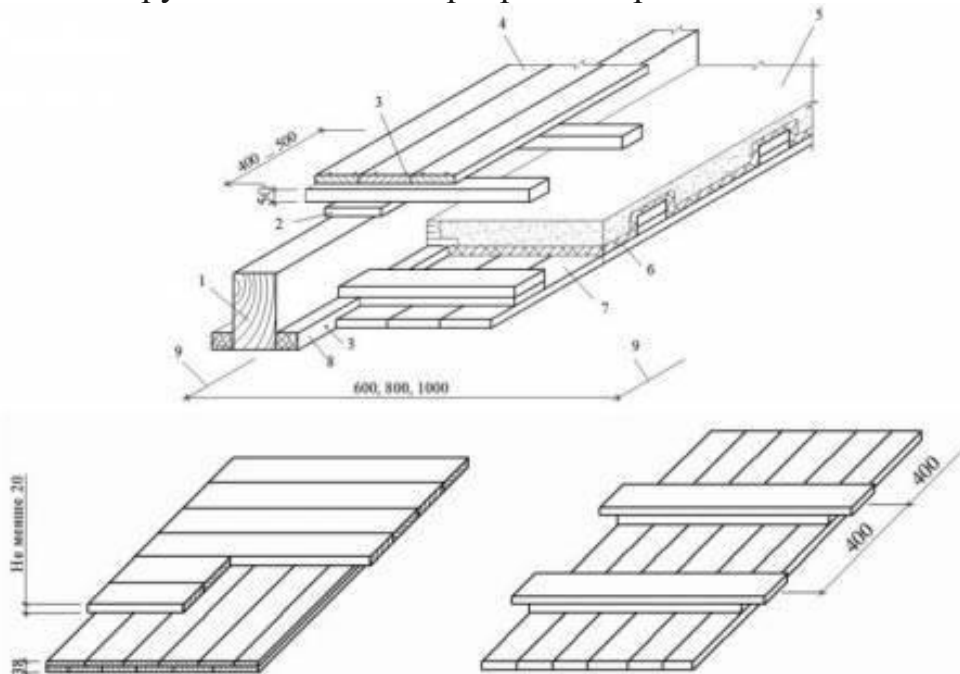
Конструкційна схема перекриття дерев'яними балками
